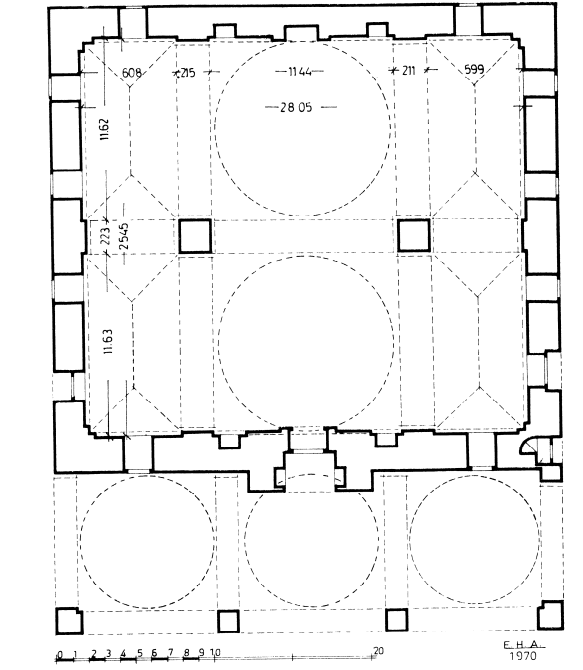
مسقط افقي لجامع بابا آدم في رامبال بالبنغال (M.Kiel)
